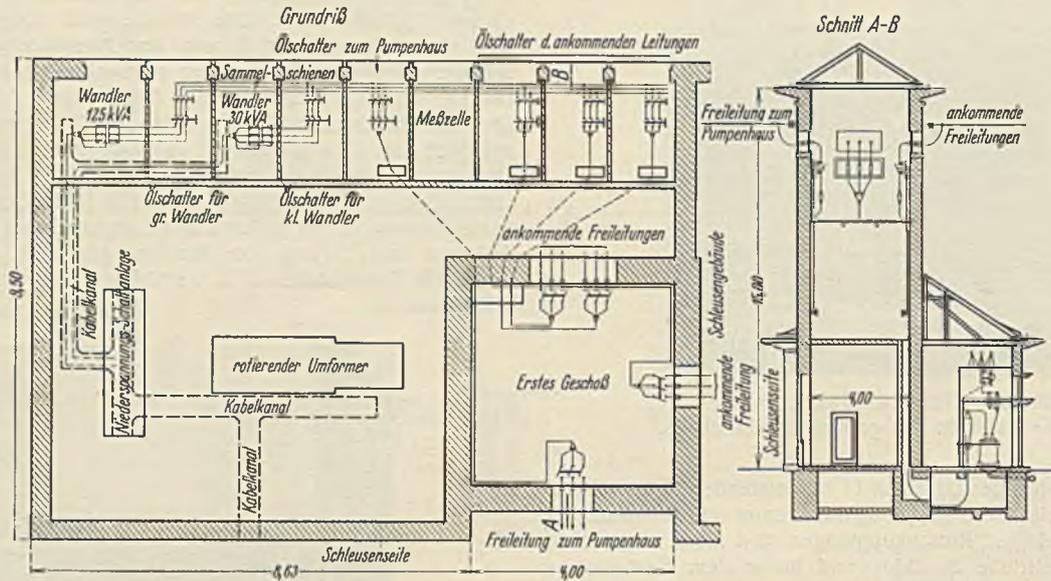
Umformer- und Schaltheis. Grundriß und Querschnitt.
